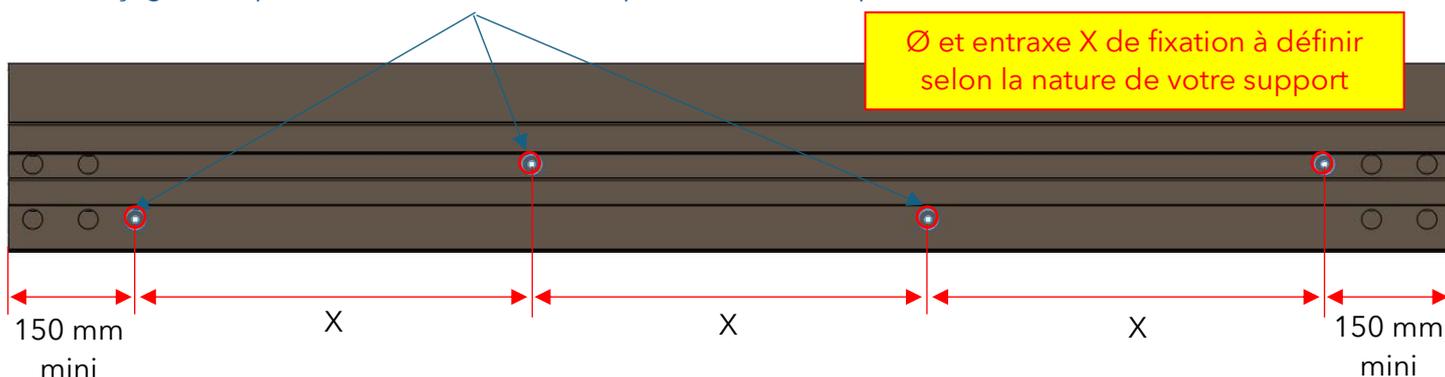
DETAILS FIXATION MURALE - POSE ADOSSÉE (fixation spécifique)
